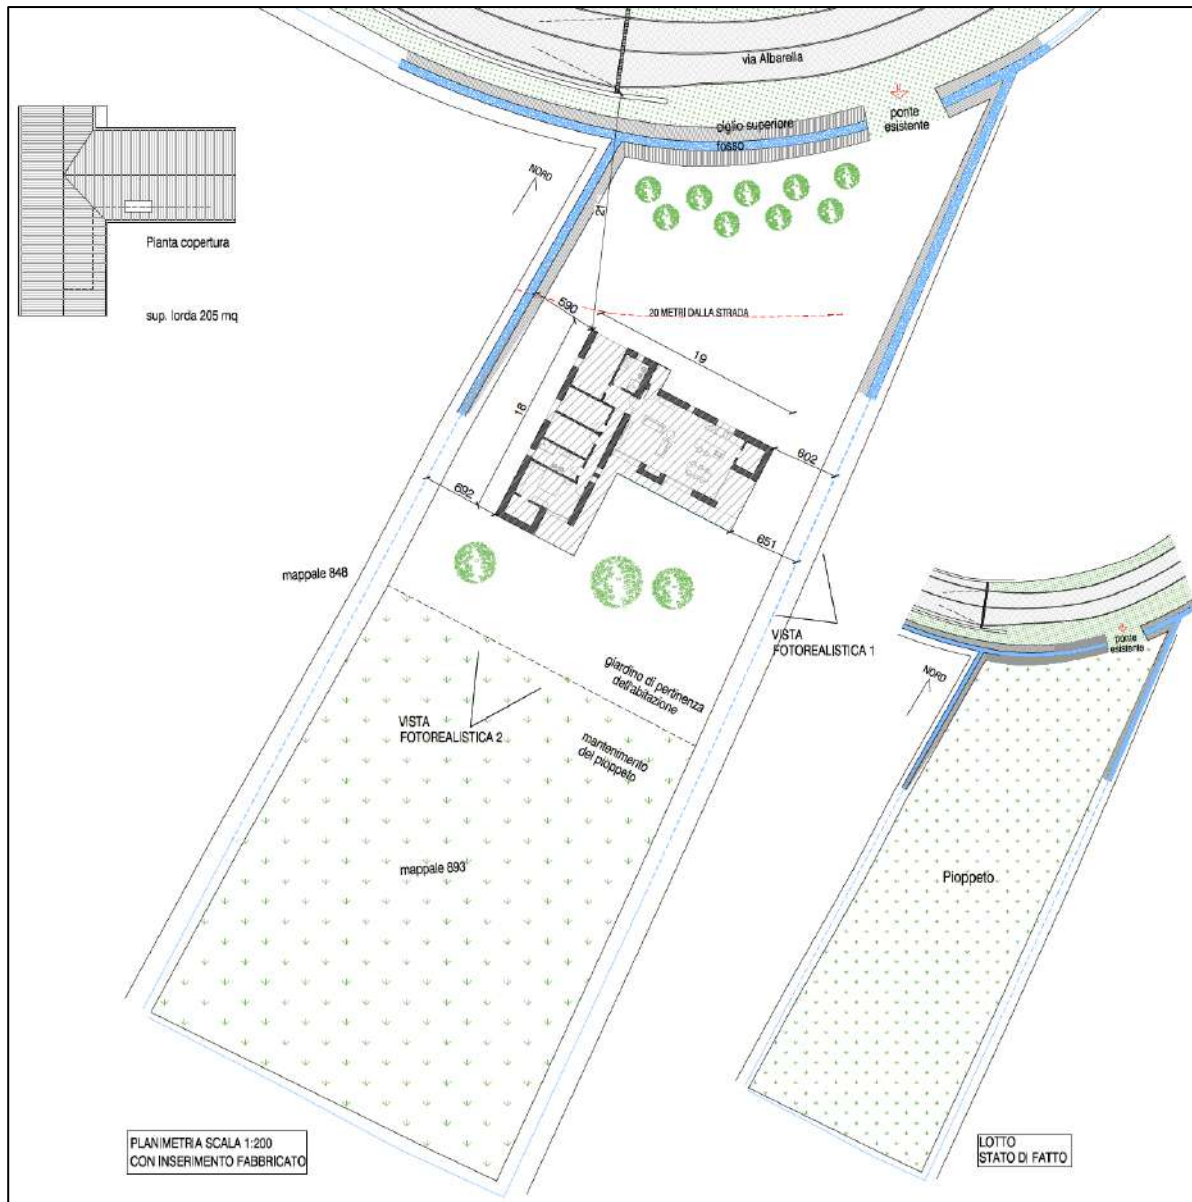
Planimetria con inserimento del fabbricato e lotto con lo stato di fatto.
